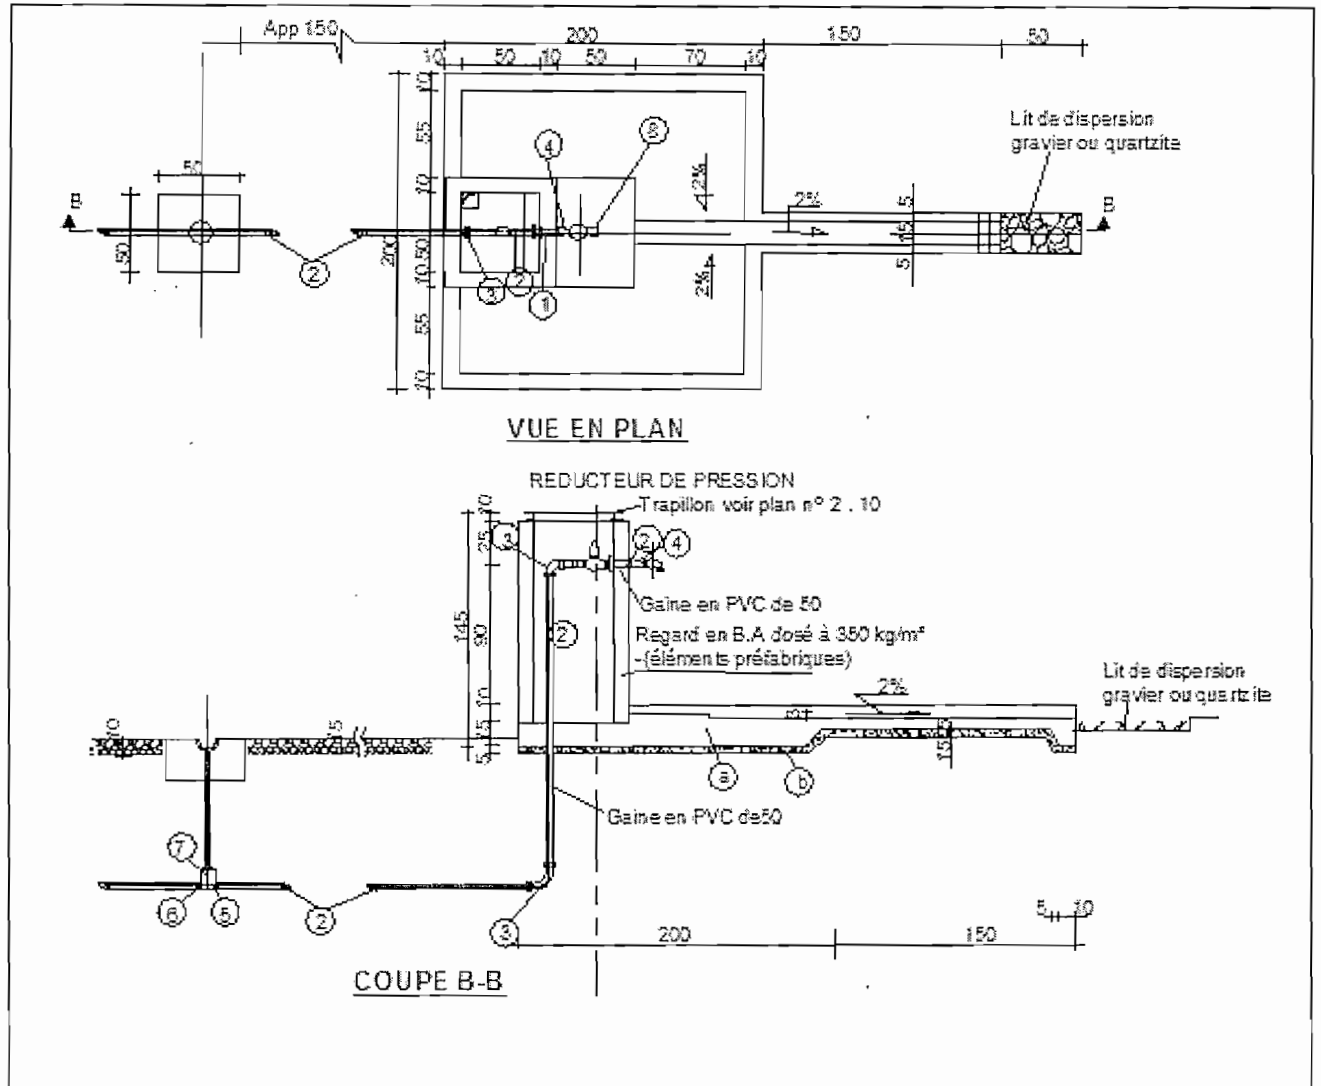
Vue en plan et coupe B-B d'une borne fontaine
